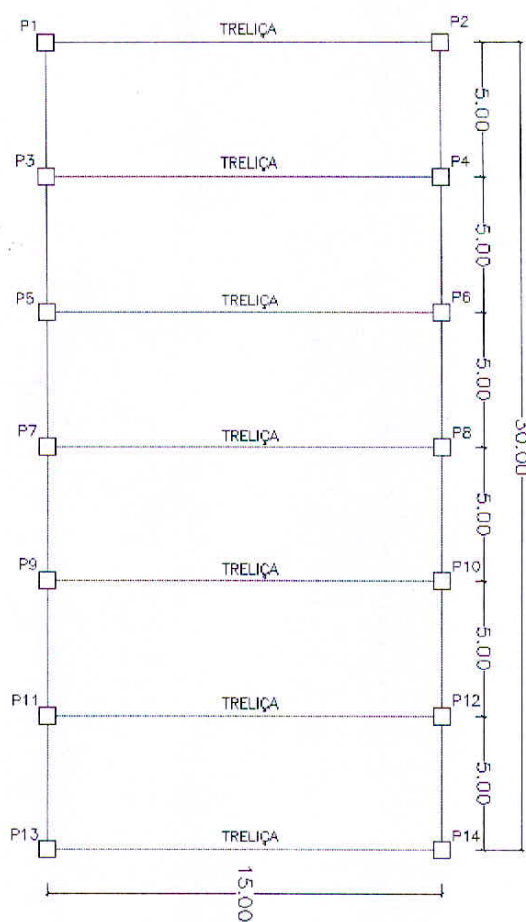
Vista superior do galpão - cotas em metros (m). – (Fonte própria).
